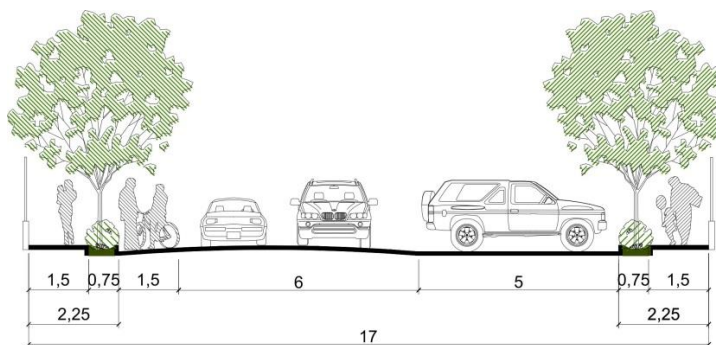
Perfil da VIA LOCAL – 1 faixa de estacionamento
